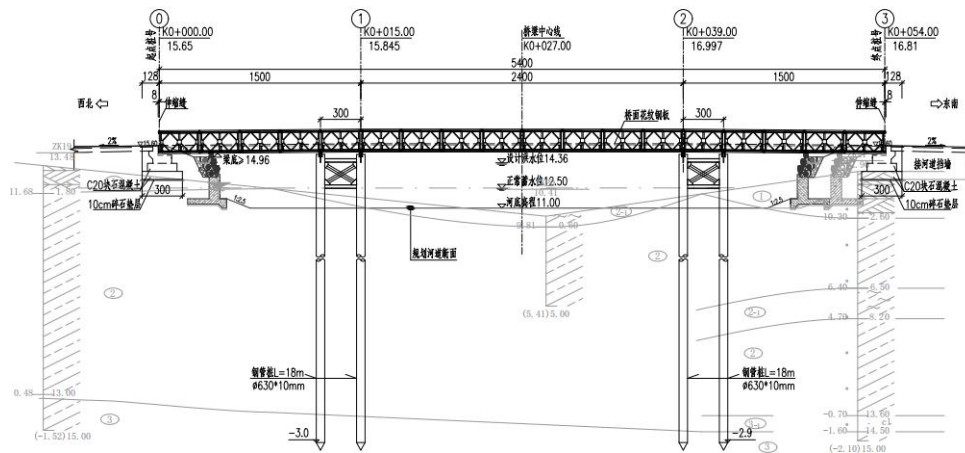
桩号 K2+072 南山湖村墩桥立面图
